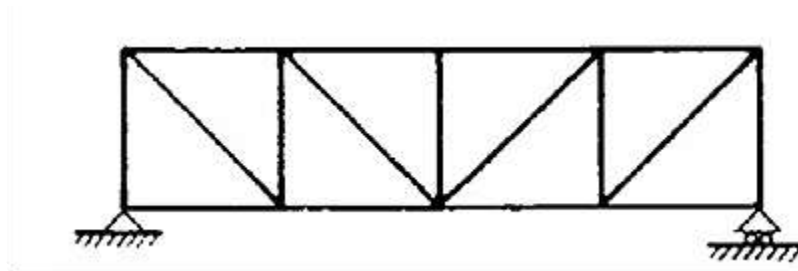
Esquema de viga Pratt exteriormente isostática
